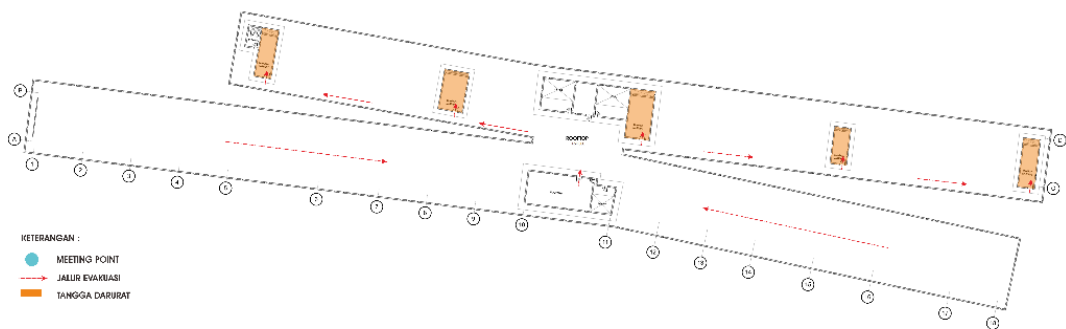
Rencana Jalur Evakuasi Lantai Tipikal 1-3, 5-7, 9-11, 13-15.
